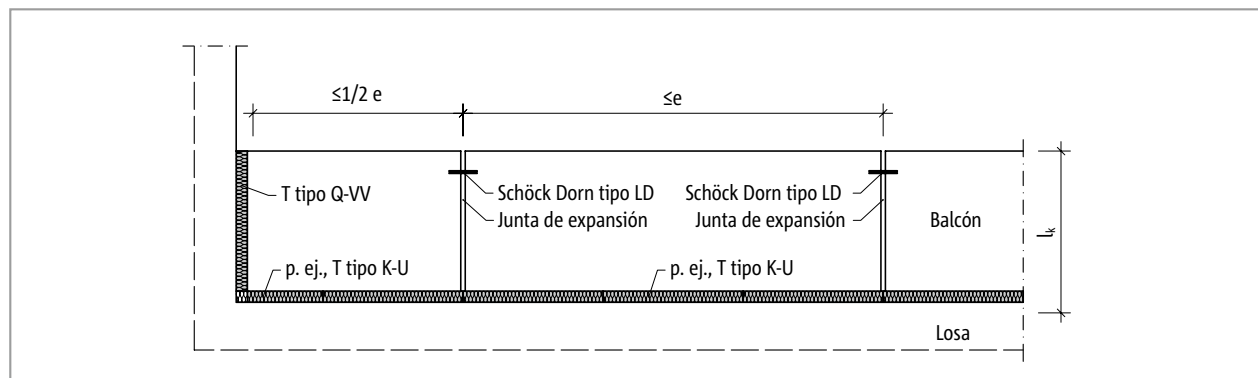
Schöck Isokorb® T tipo K-U: Disposición de las juntas de expansión
